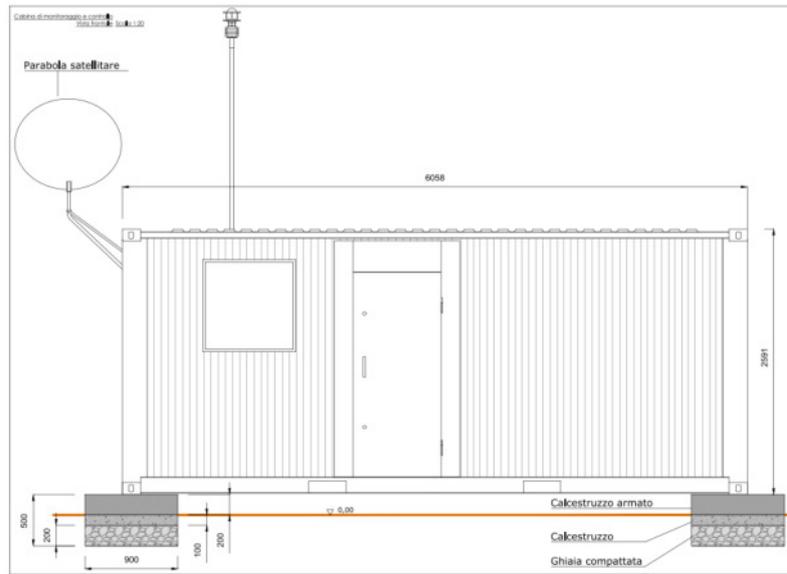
Vista in prospettiva della cabina di monitoraggio tipo.
